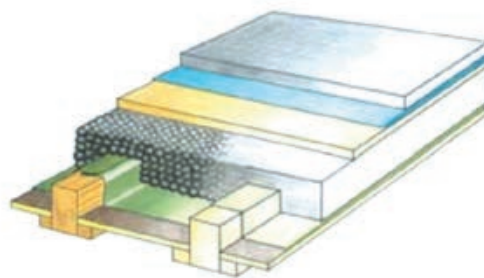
Jednostavno poravnanje između drvenih elemenata stropa [300]
